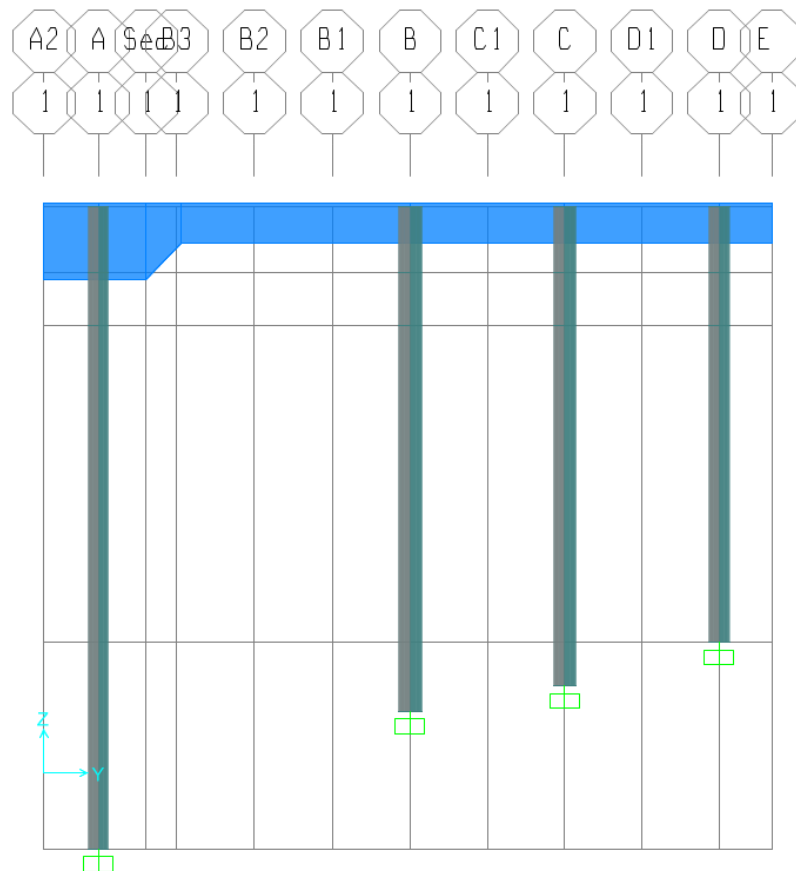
Vista en elevación del plano 1 de modelación, paralelo a plano Y-Vertical.
